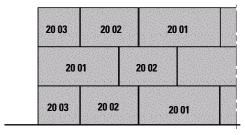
Pose en quinconce aux multiples de 10 et 20 cm
